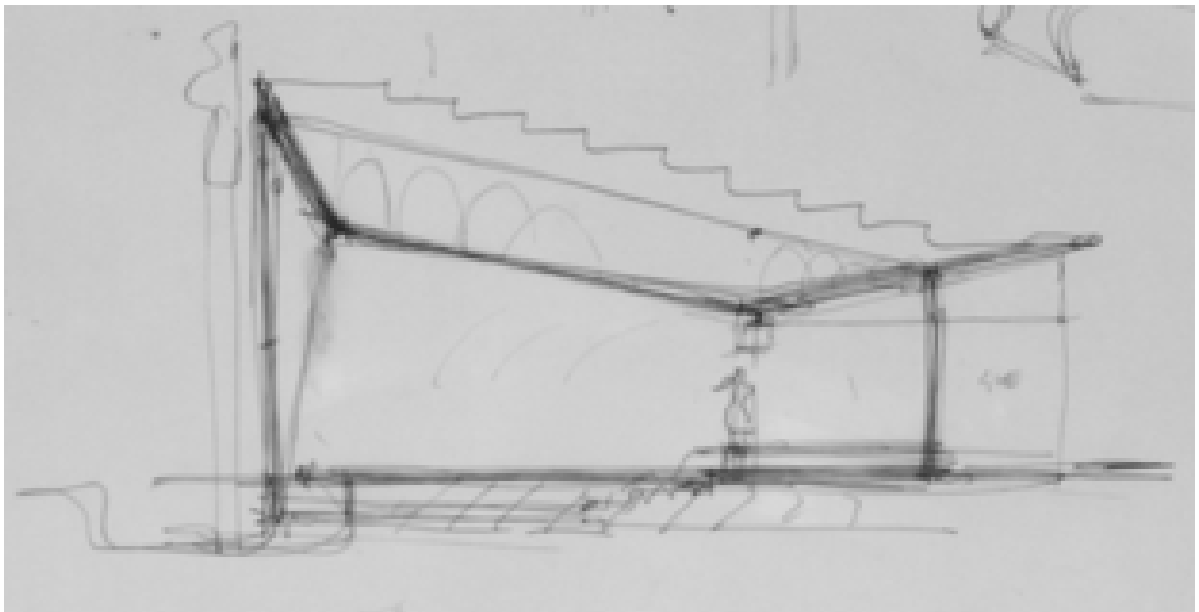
Prima ipotesi di sezione trasversale tipo (AABS-947)
